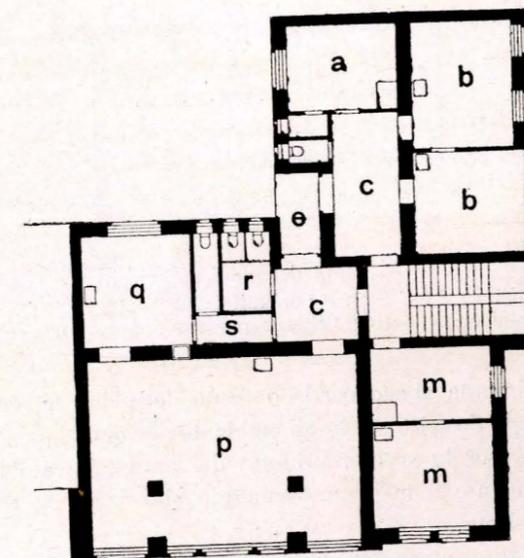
Pianta del piano terreno rialzato. Alloggio: a Cucina; b Stanza per abitazione; c Ingresso; e Balcone coperto.
